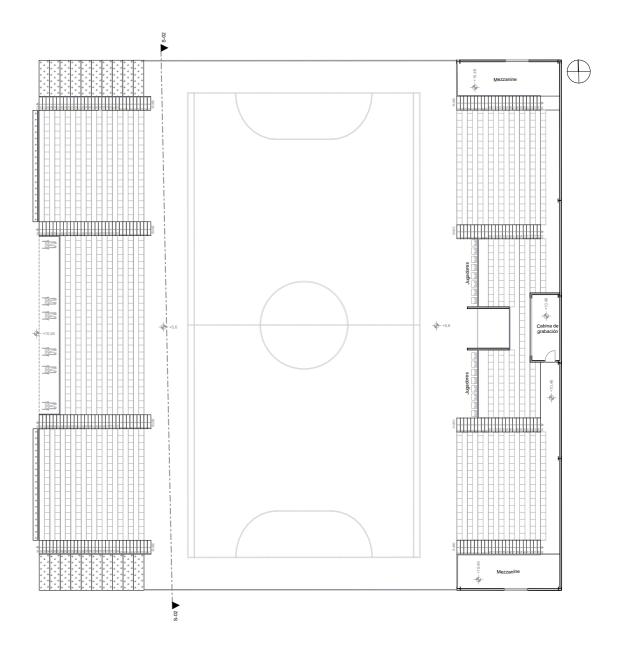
Bloque 4 - planta +11,46 ESC_1:325 Elaborado por: Autor
